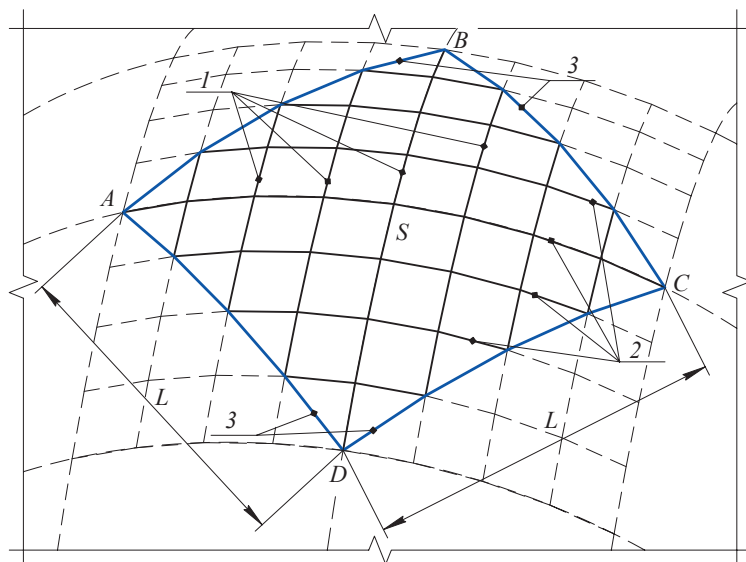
Стержневая модель конструкции оболочки: 1 – арки одного направления; 2 – арки другого направления; 3 – опорный контур
